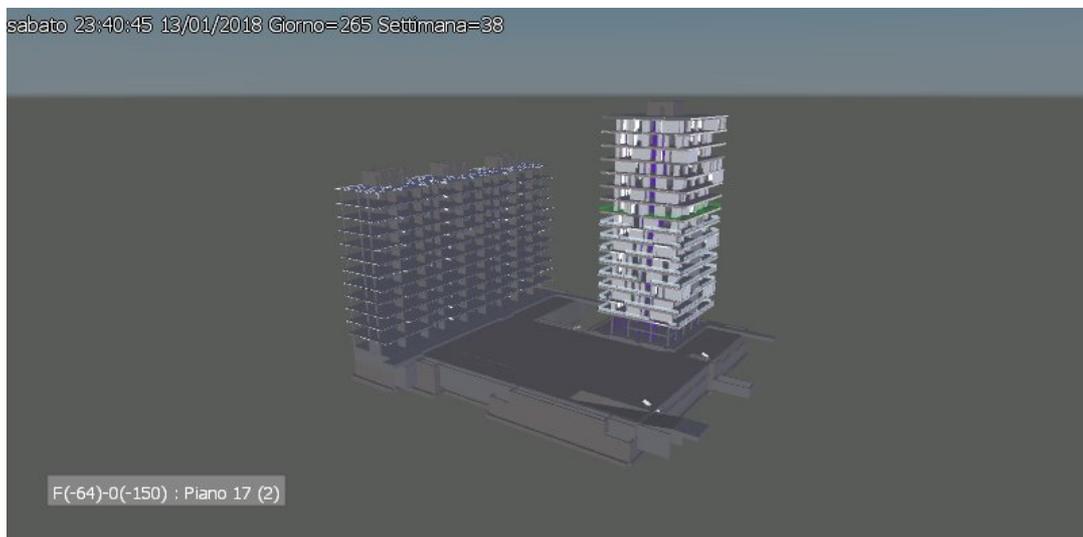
Simulazione 4D - Struttura Garden ultimata e Montaggio parapetti Tower
